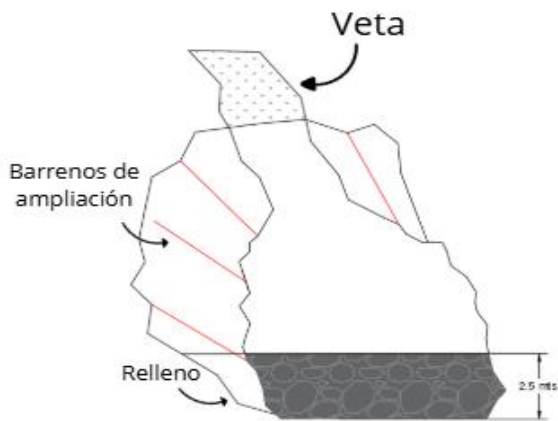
Vista transversal de voladura con barrenos de ampliaciones
